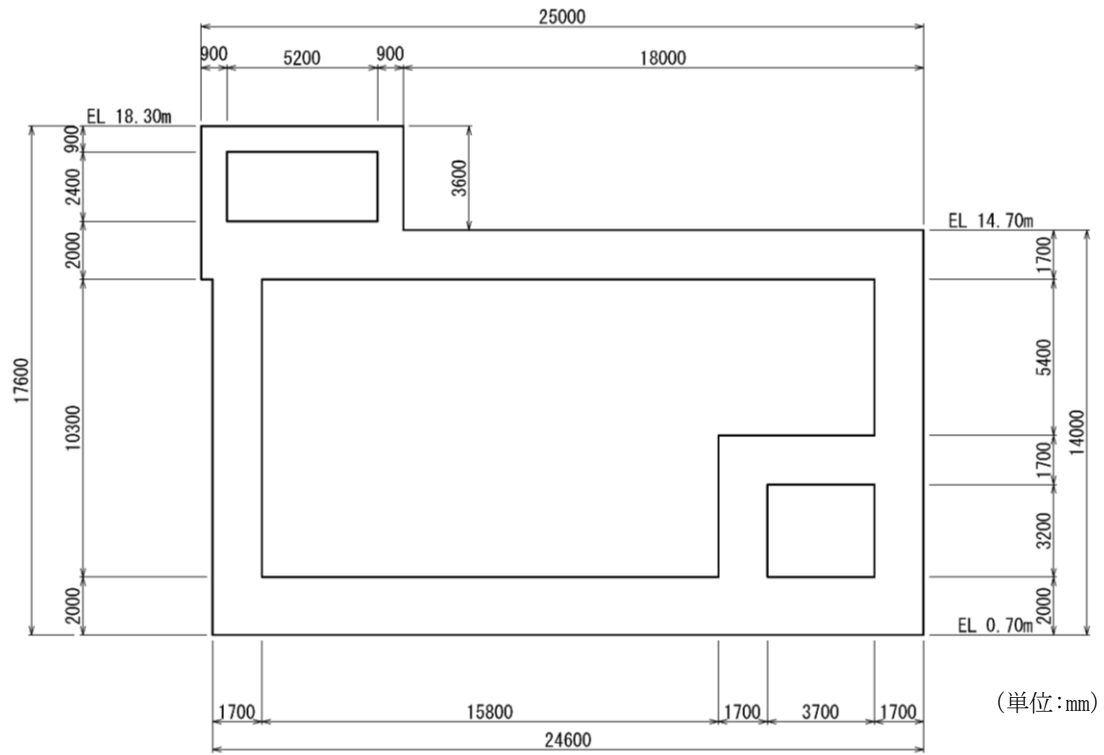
第 1 ベントフィルタ格納槽 断面図 (C-C 断面)
